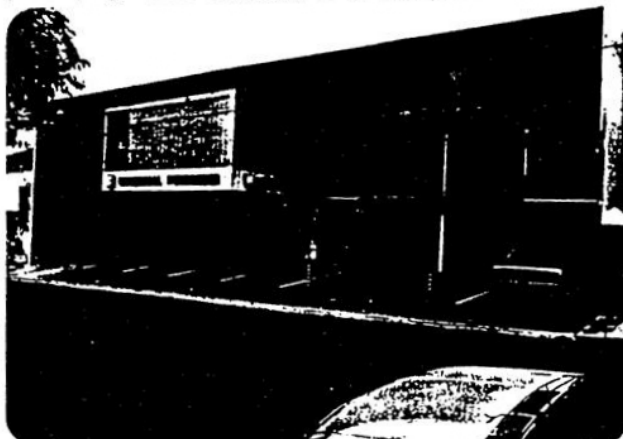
Estrutura em concreto aparente com ar incorporado.
